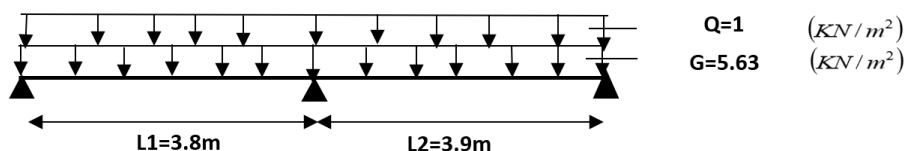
Poutrelle type 1 (Terrasse)
